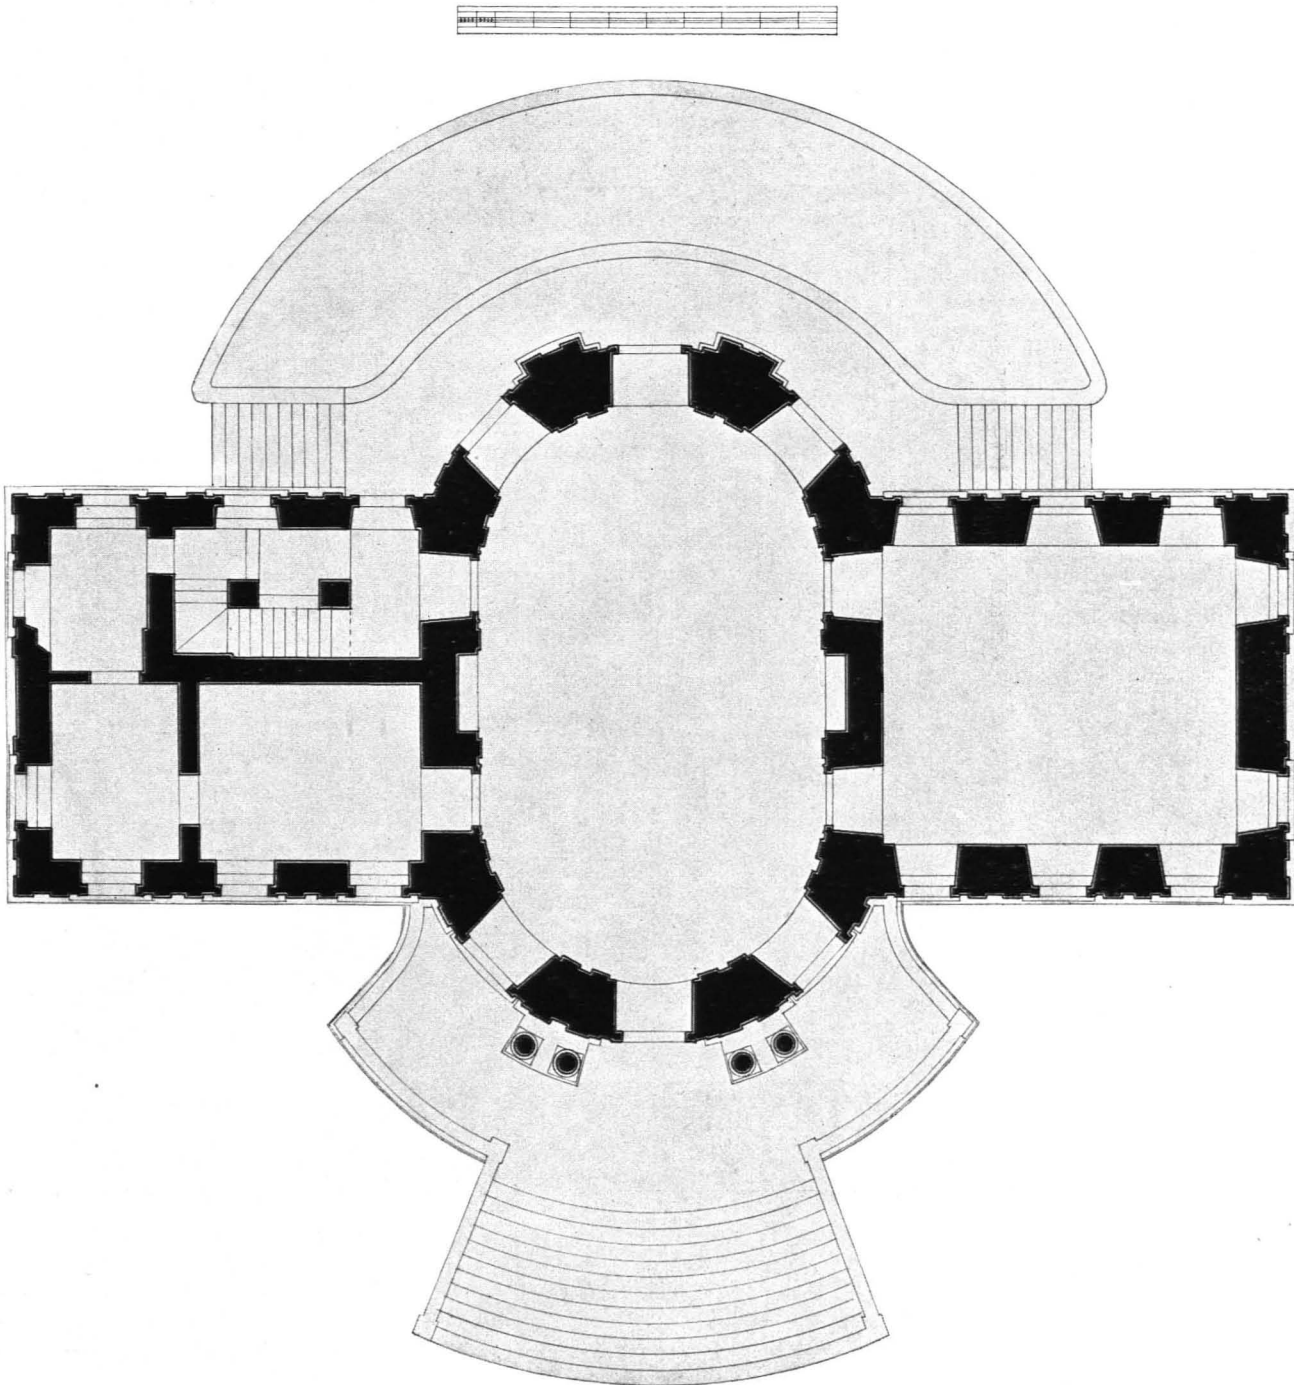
Melk, Stift, Gartenpavillon, Grundriß (S. 368)
